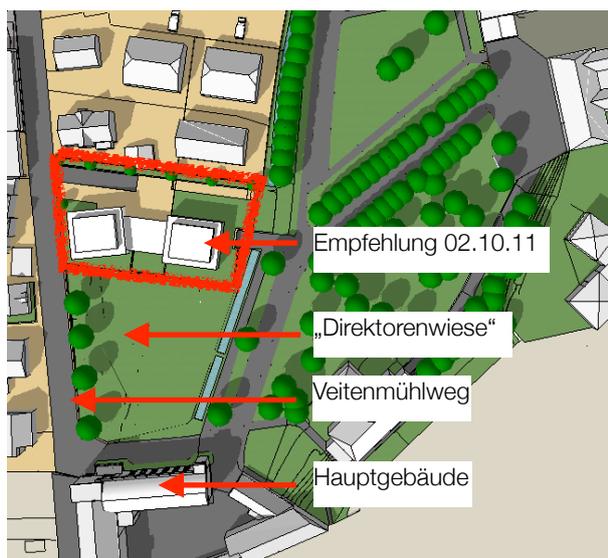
„Städtebauliche Empfehlung, 02.10.11“
